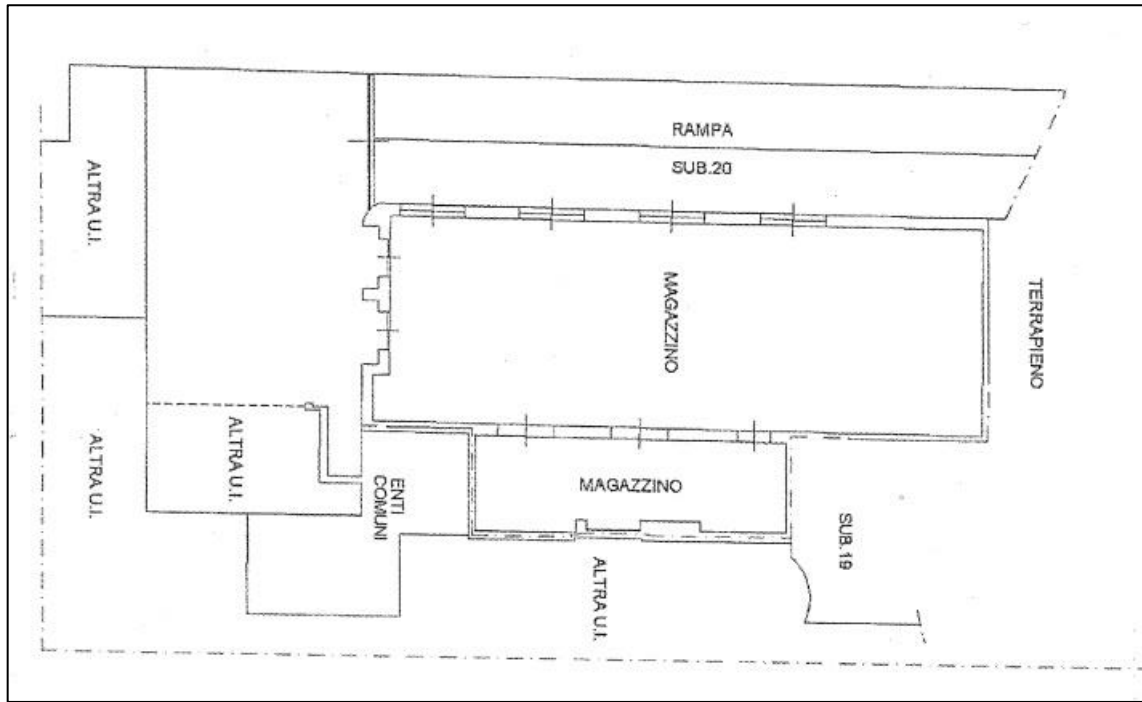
planimetria dell'unità immobiliare ad uso deposito
